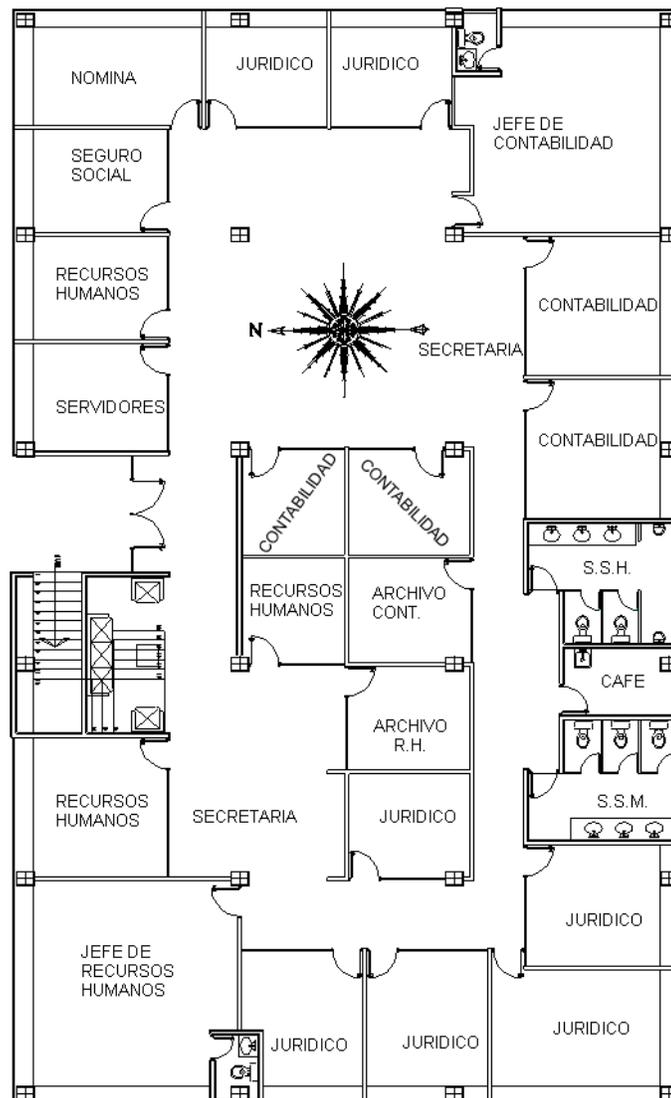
Croquis edificio Anexo Administrativo Planta Baja.
